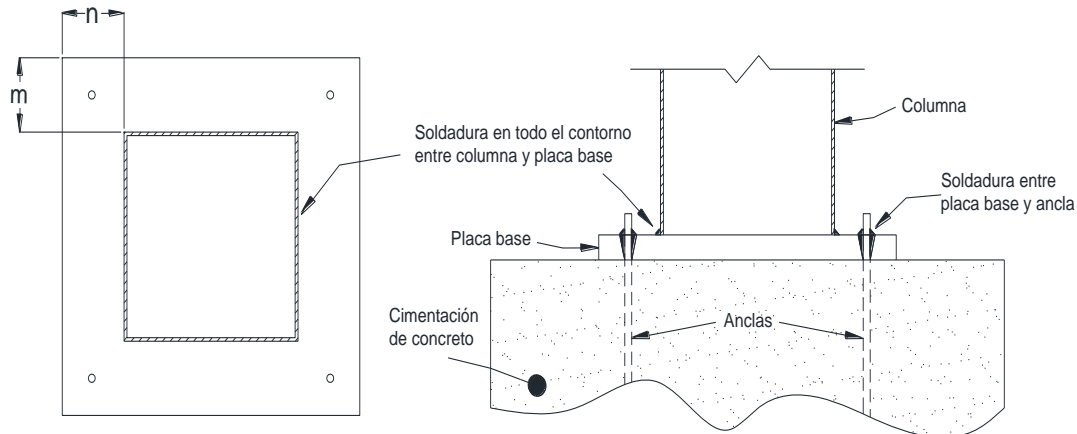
Conexión soldada tipo columna – placa base – concreto
